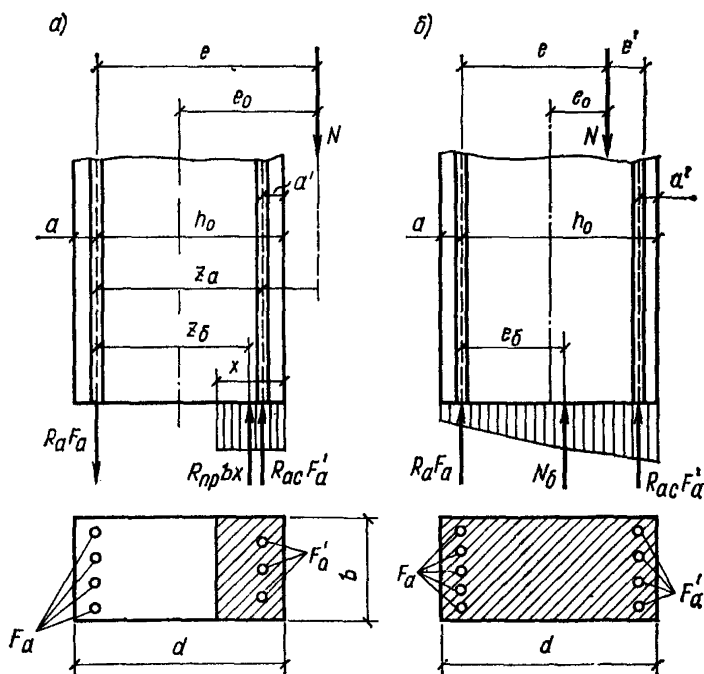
Схема усилий и эпюра напряжений внецентренно-сжатых железобетонных элементов прямоугольного сечения
